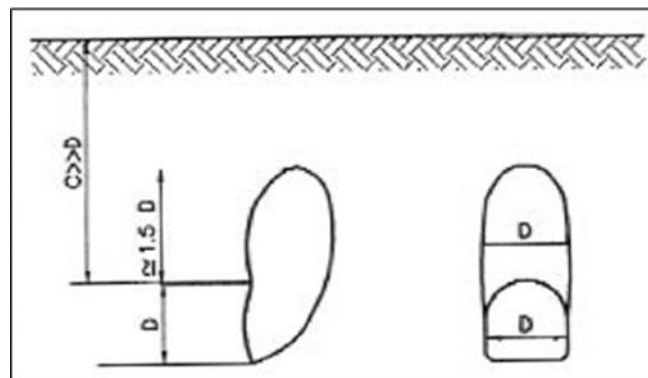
Mécanisme secondaire : coupe transversale de principe
